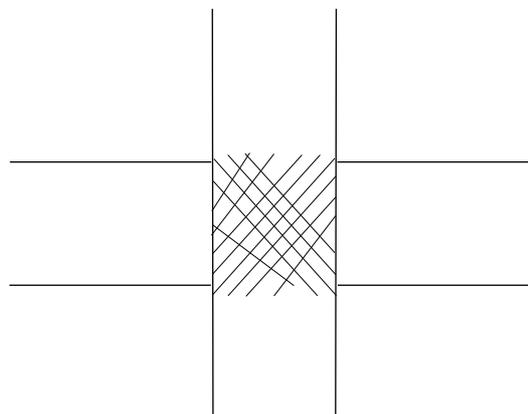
RC構造の柱梁接合部とひび割れの状況
